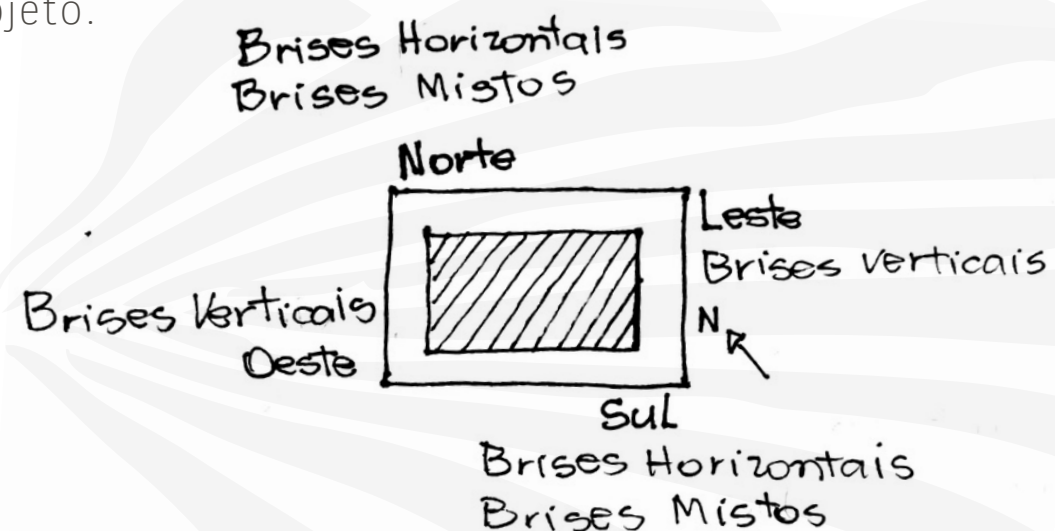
Croqui de locação dos tipos de brises-soleil indicados para cada fachada . Fonte: Elaboração própria da autora.
